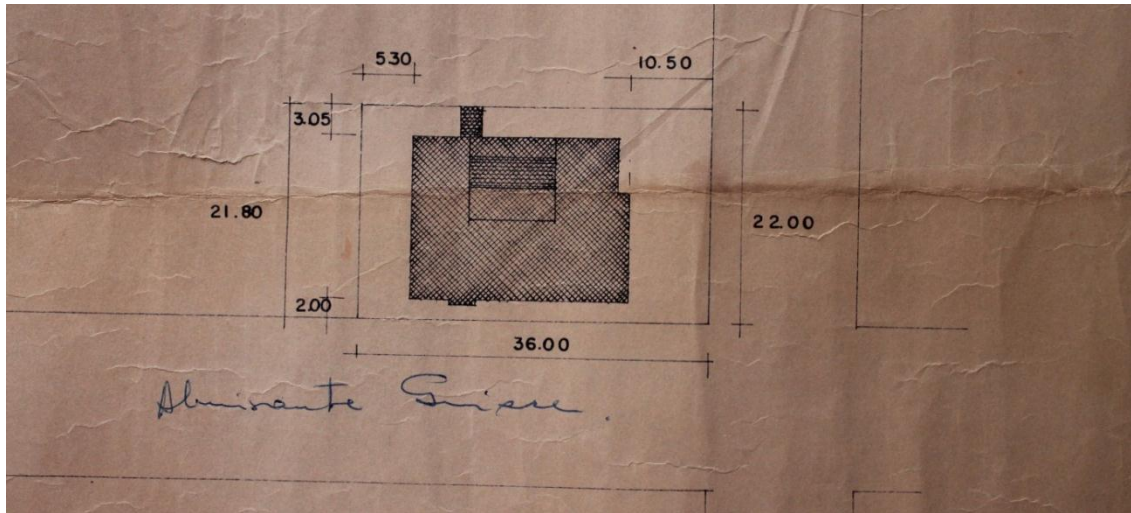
Plano emplazamiento. Fuente: Propia.
